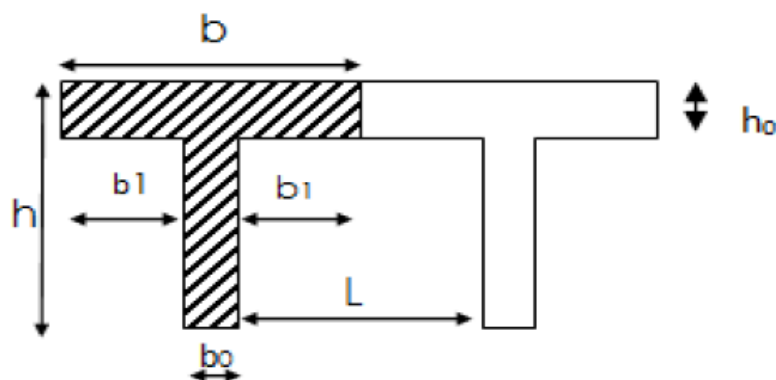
Surfaces revenant aux poutrelles.
